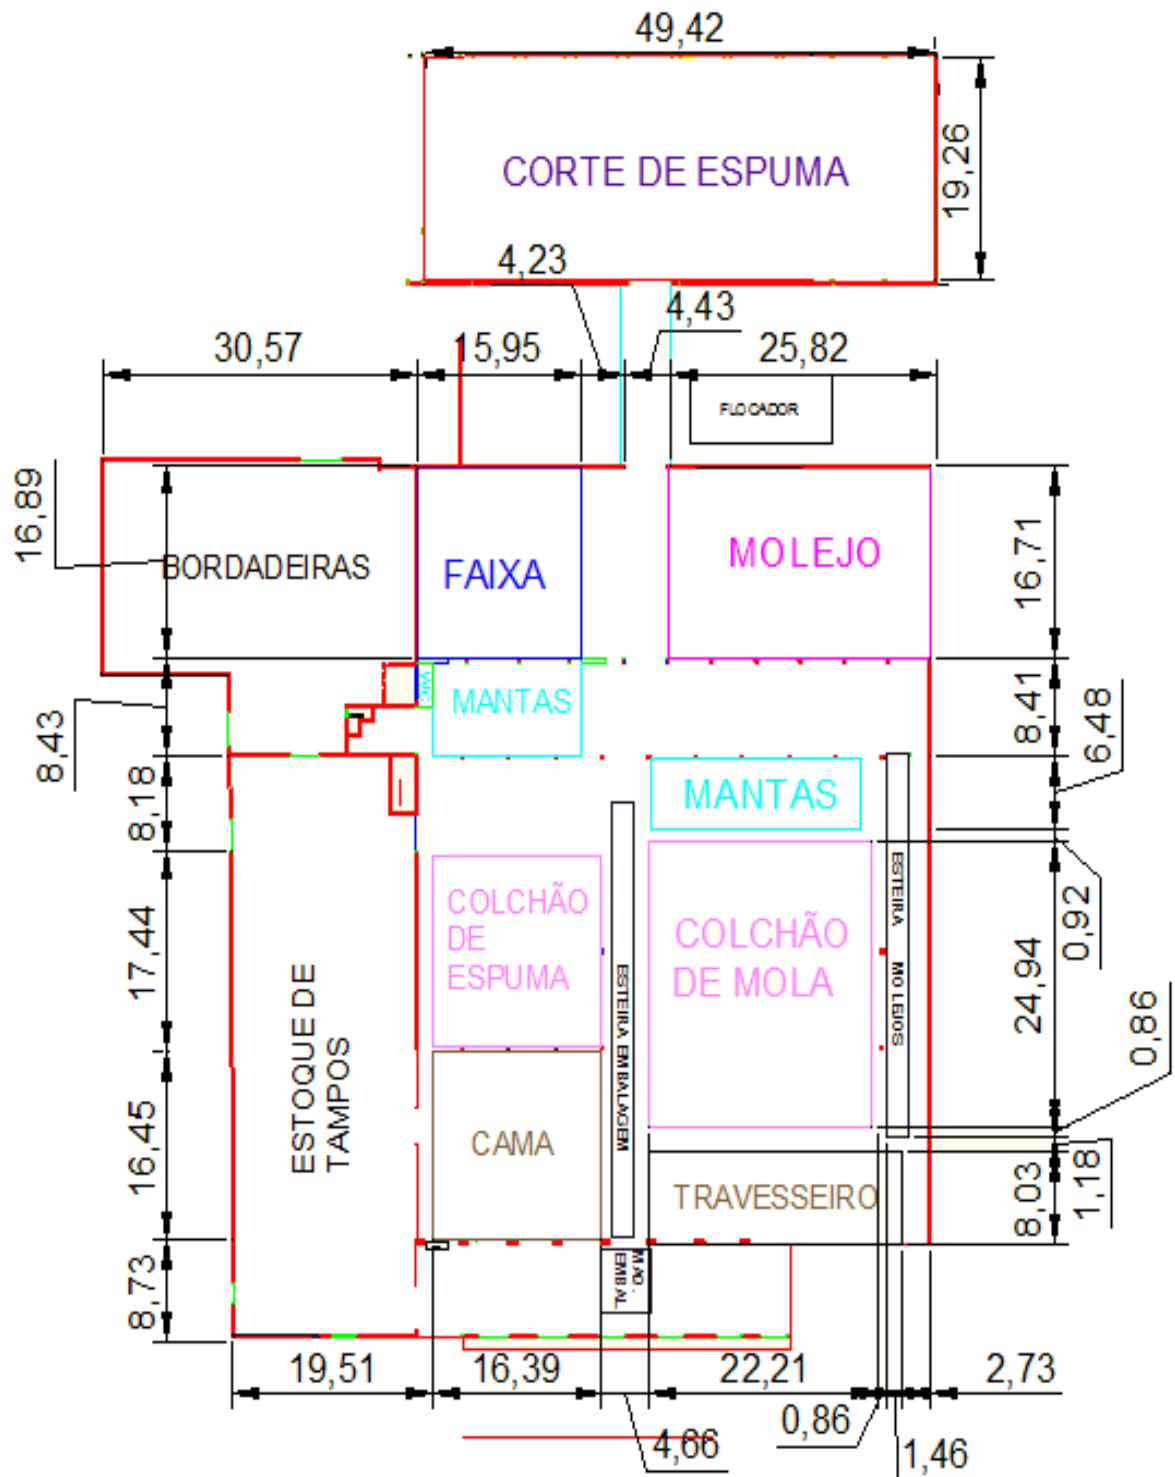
Proposta de Planta Baixa para F.A Maringá com cota
